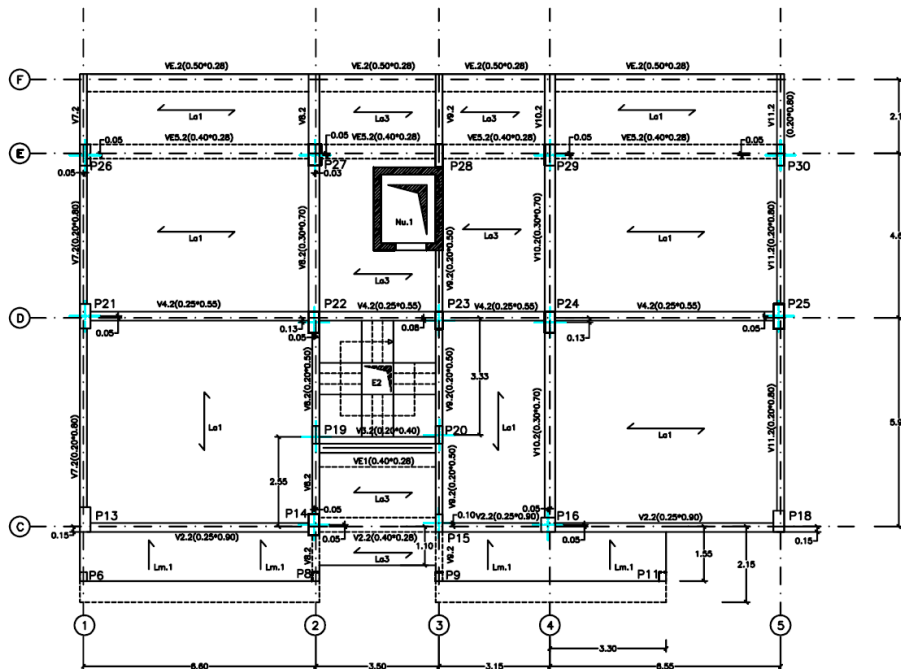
Planta estrutural do piso tipo do edifício de exemplo
